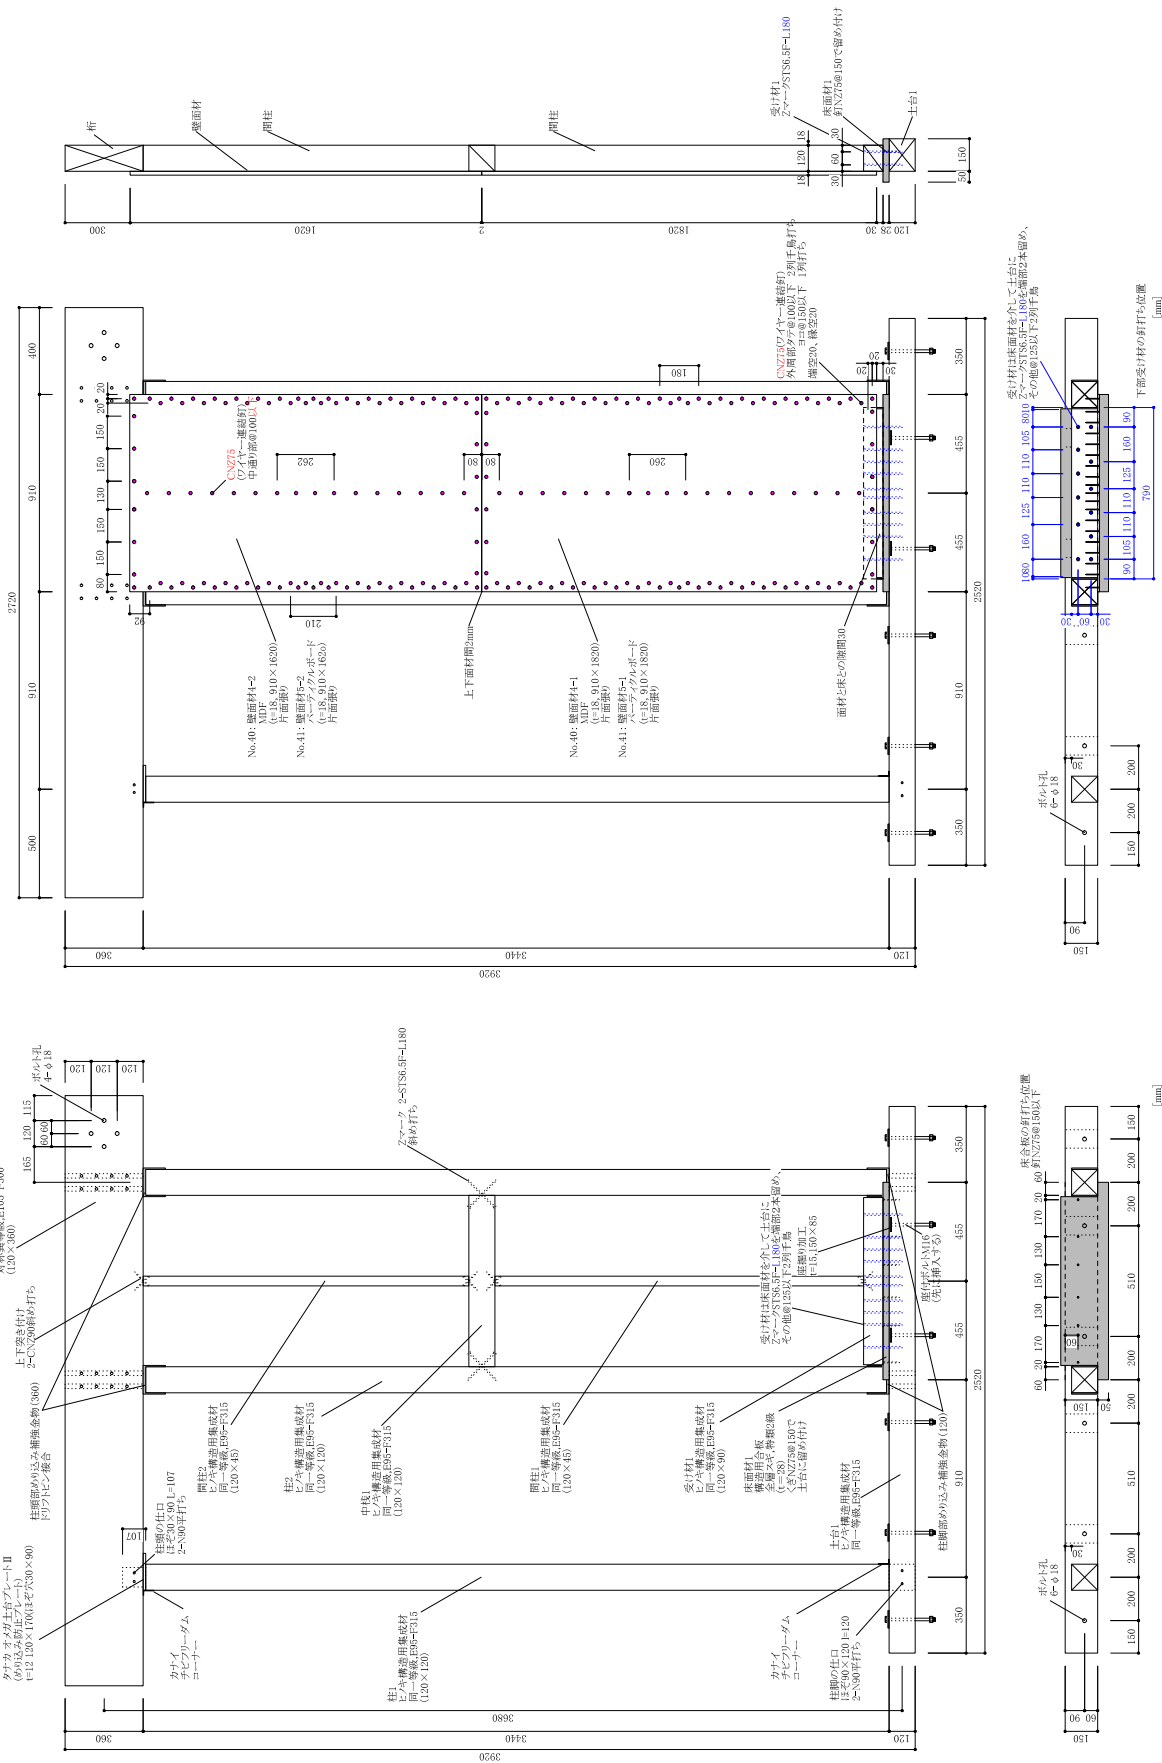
2: No.40-1, No.41-1 試験体の詳細図 (mm)
